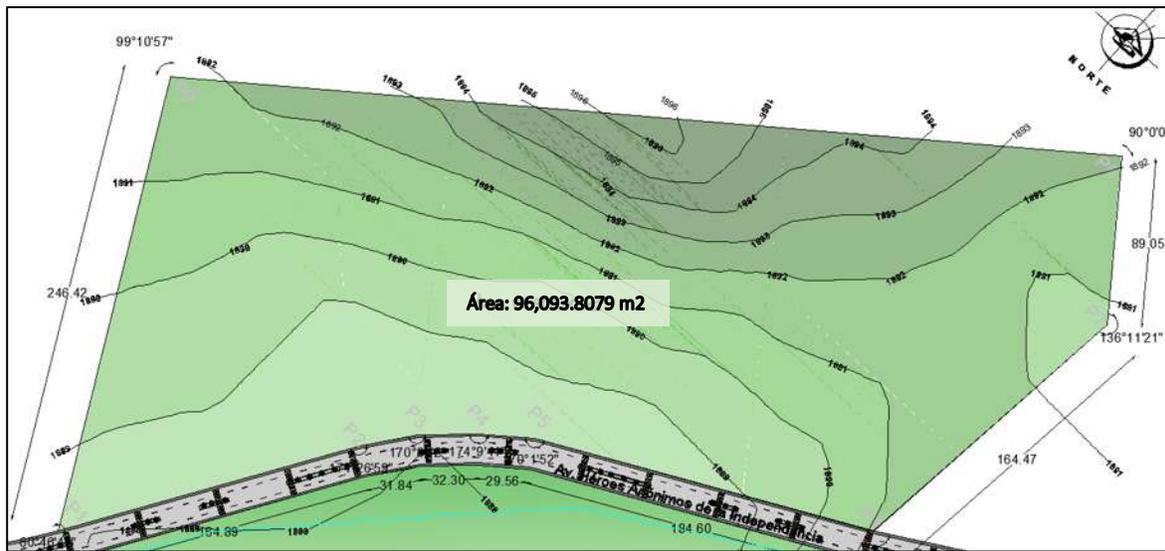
Topografía del terreno. Fuente: elaboración propia
